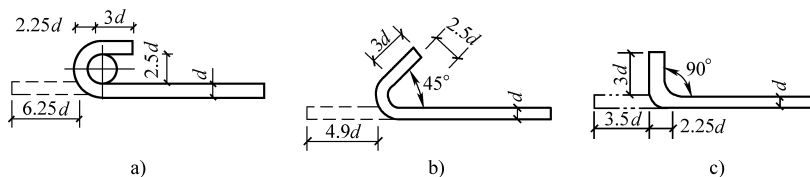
钢筋弯勾形式示意图及钢筋增加的长度
